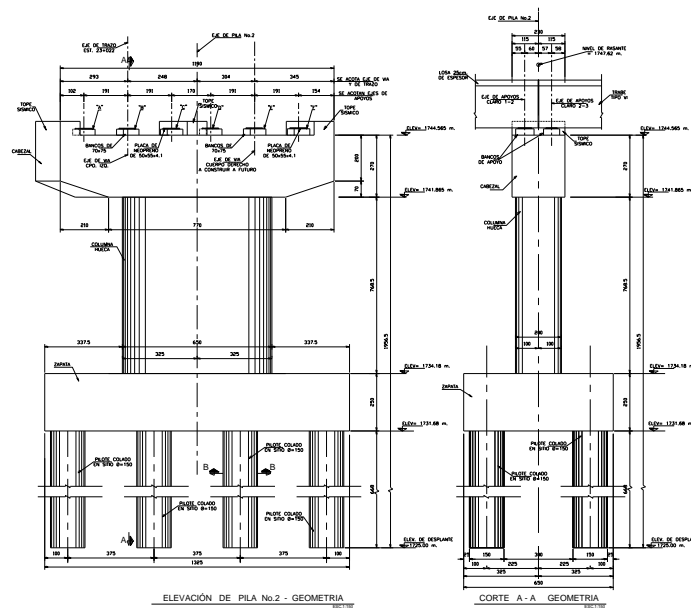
Geometría general de la pila intermedia no.2 y no.3.
